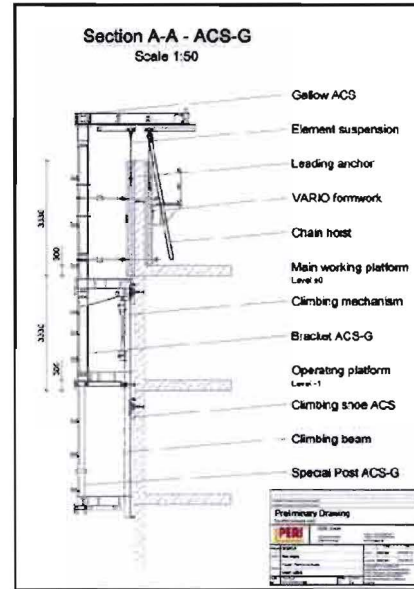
Klimfasering van het ACS-G klimsysteem voor de façadewanden
